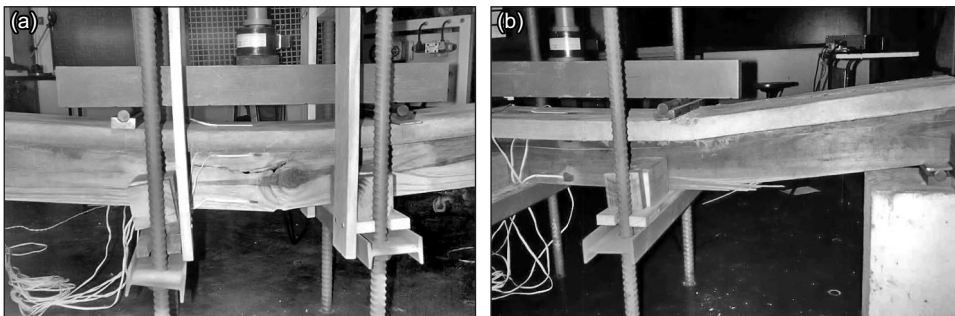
Ruptura nos pontos de aplicação da força nas vigas mistas: a) viga 1 e b) viga 3.
